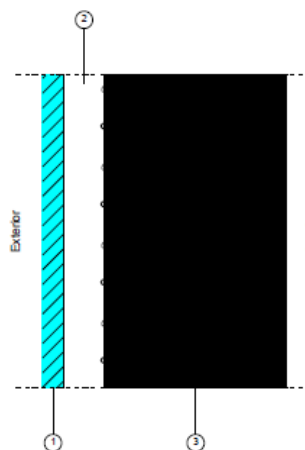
Detalle constructivo de los componentes del muro trombe.
